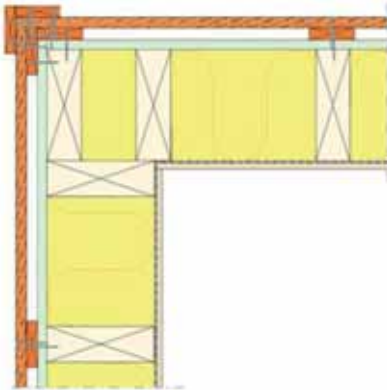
A cofragem deverá ser coincidente com as vigas quando se fixarem a uma parede com estrutura de madeira. O desenho esquemático não proporciona um design estrutural.
